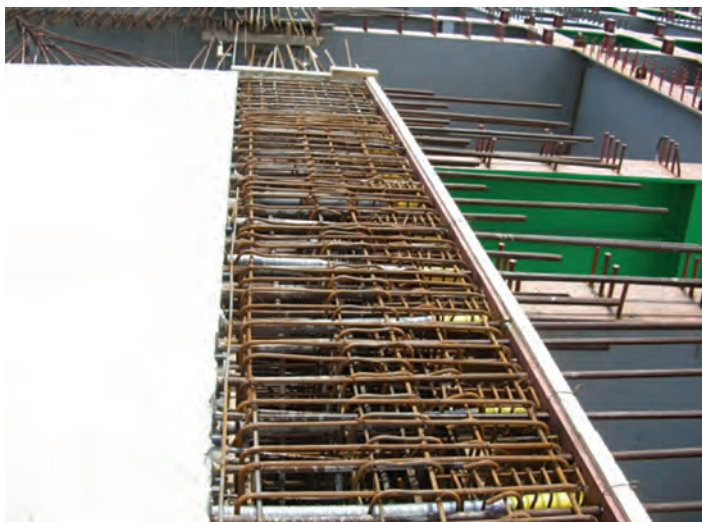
Armare antretoază în zona de legătură dintre tablierul metalic și tablierul din beton precomprimat
